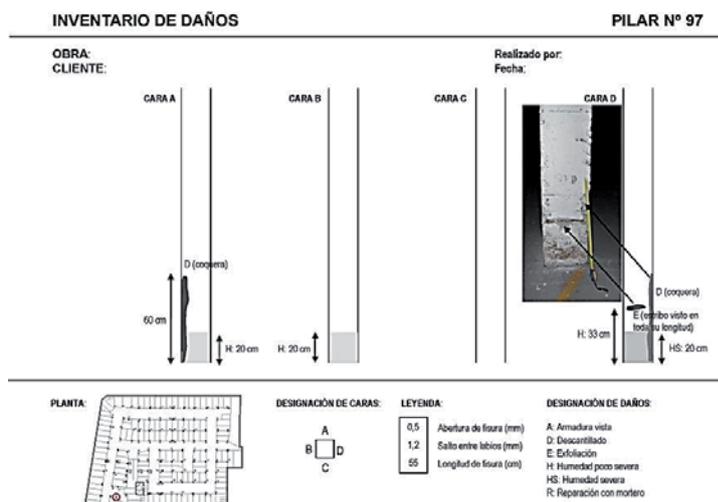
Fichas de inspección del estado de los pilares en la planta de sótano
